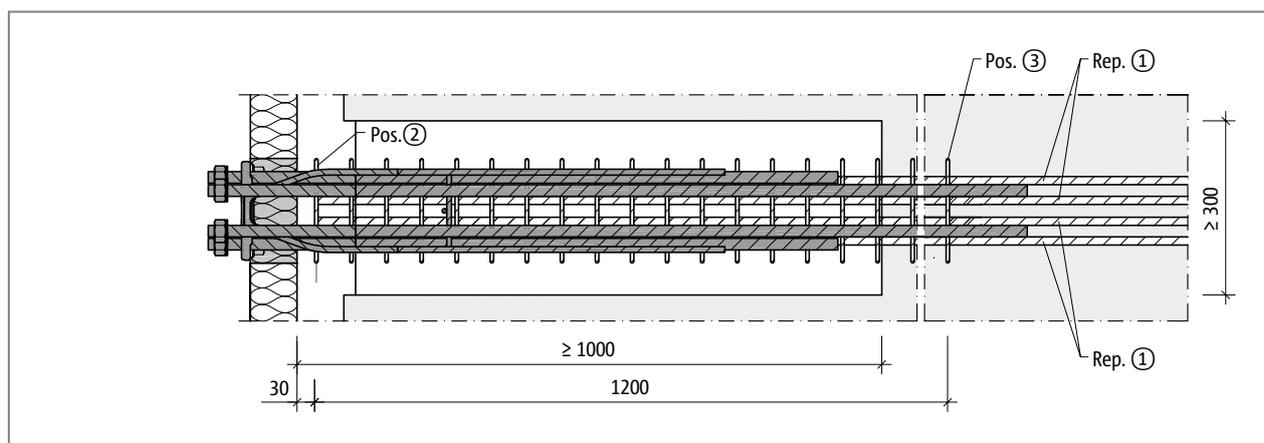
Schöck Isokorb® T type SK-MM2 : renforcement sur site pour construction semi-préfabriquée, plan de base
